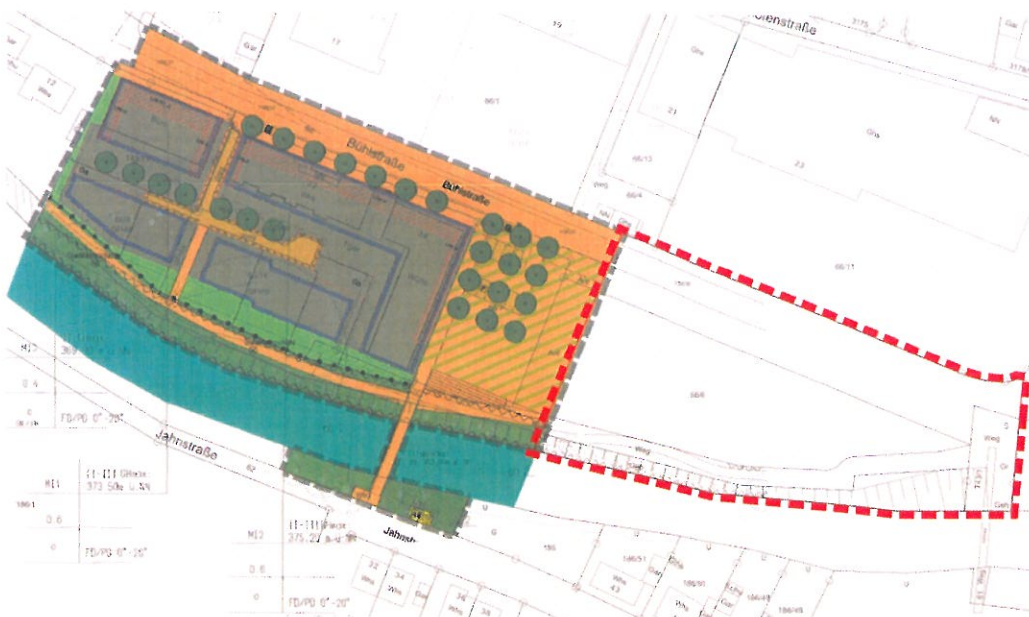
Bebauungsplan "Bühlstraße Erweiterung I - Süd 1. Änderung", in Kraft getreten am 18.09.2008
